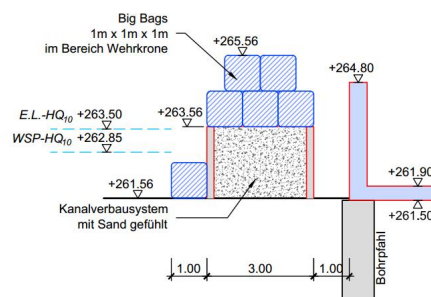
Querschnitt B-B aus dem Plan „Situation Bauetappe 2“, Plan-Nr. 1010-021-019
